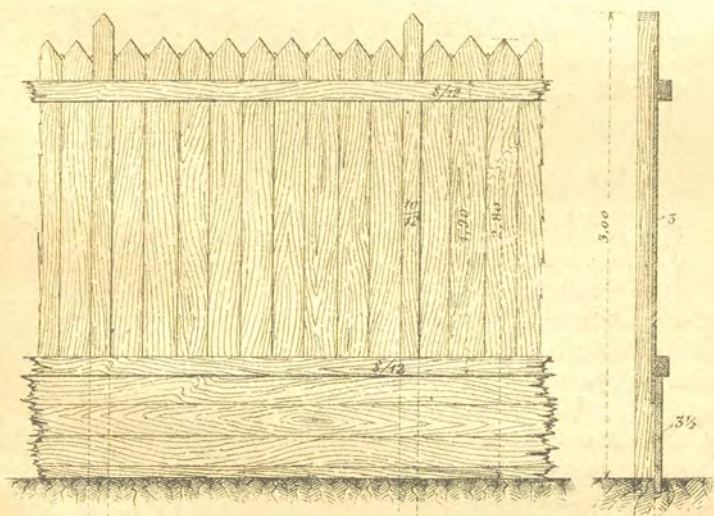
Prospetto interno e sezione trasversale. — Scala 1 a 50.
